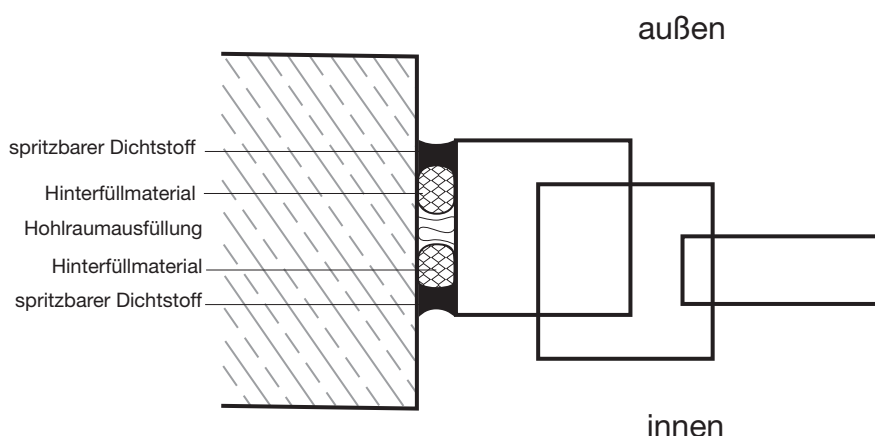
Fachgerechte Fugenausbildung bei stumpfem Anschlag.
